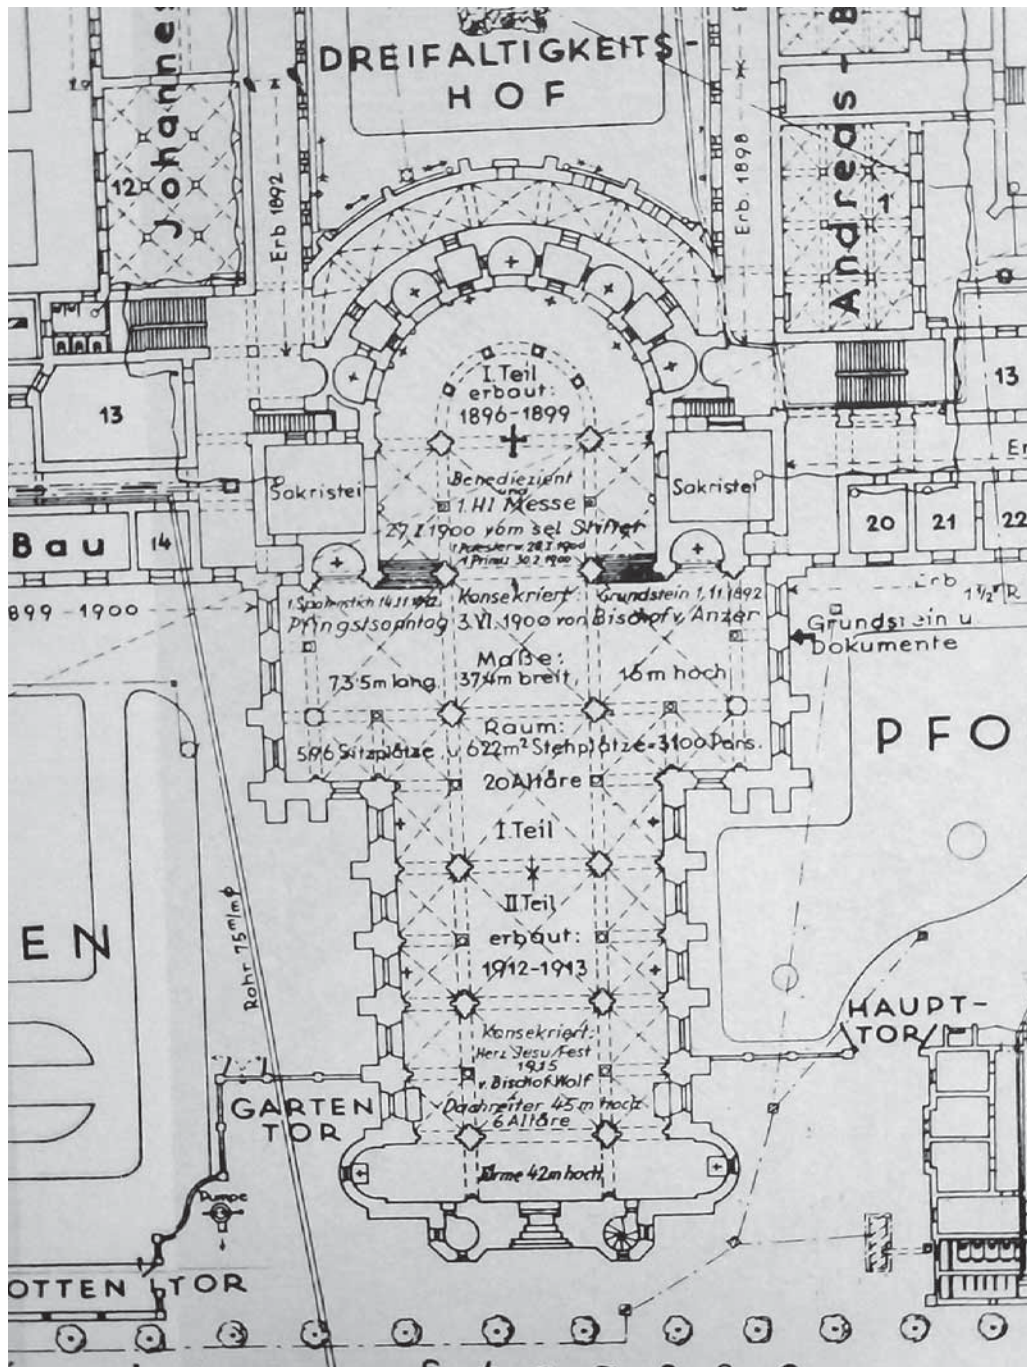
Grundriss heute Heilig-Geist-Kirche, Ausschnitt Gesamtanlageplan Missionshaus St.Gabriel
